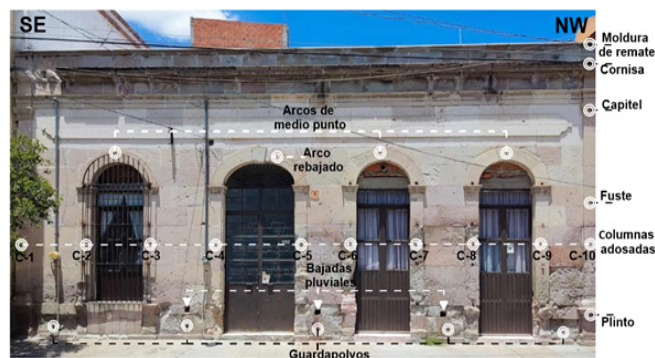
Distribución arquitectónica de la fachada y principales elementos constructivos de La Casa Rosal 102a, diseñada por el arquitecto Refugio Reyes Rivas (1862- 1943).
